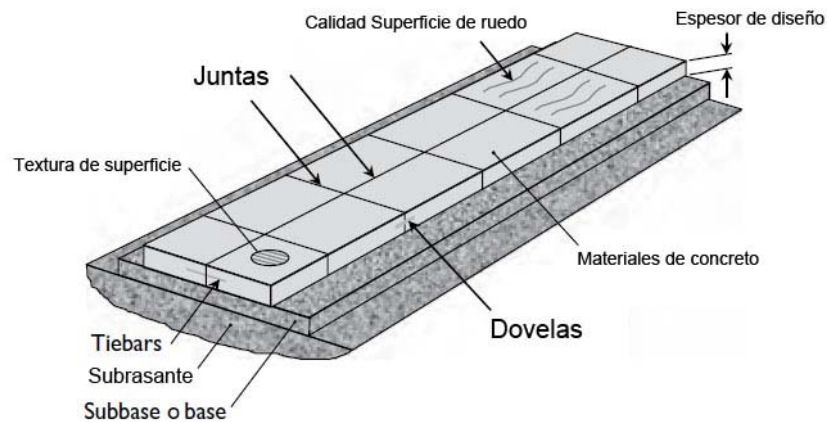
Estructura típica de los pavimentos rígidos. (Fuente: ACPA)
